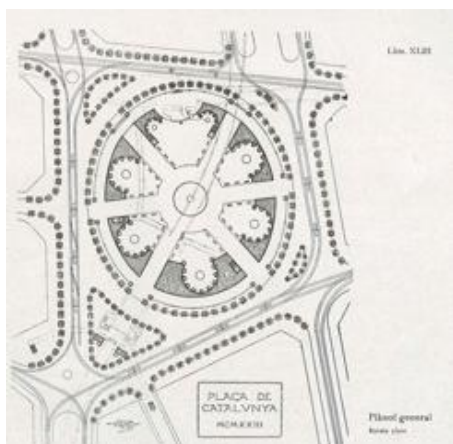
> Planta general del proyecto (Puig i Cadafalch 1927, Lam. 43)
